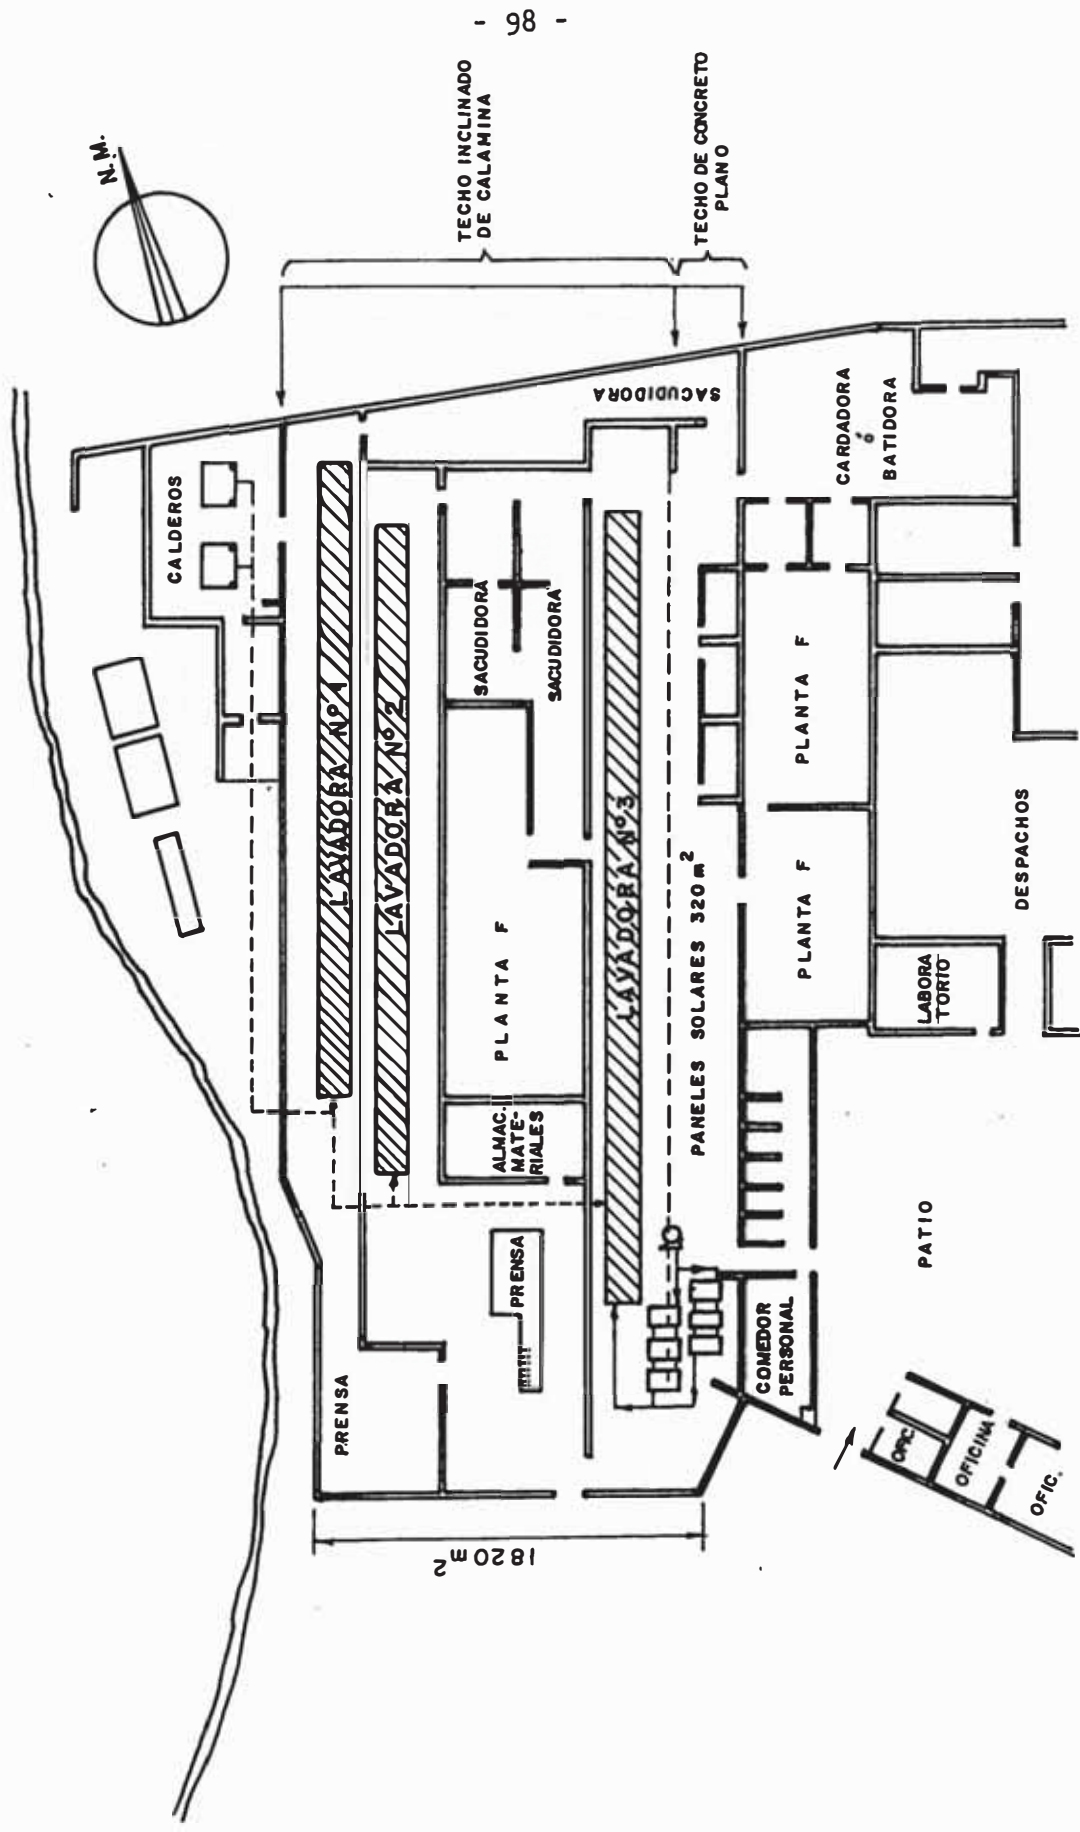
DISTRIBUCION DE LA PLANTA DE LAVADO
